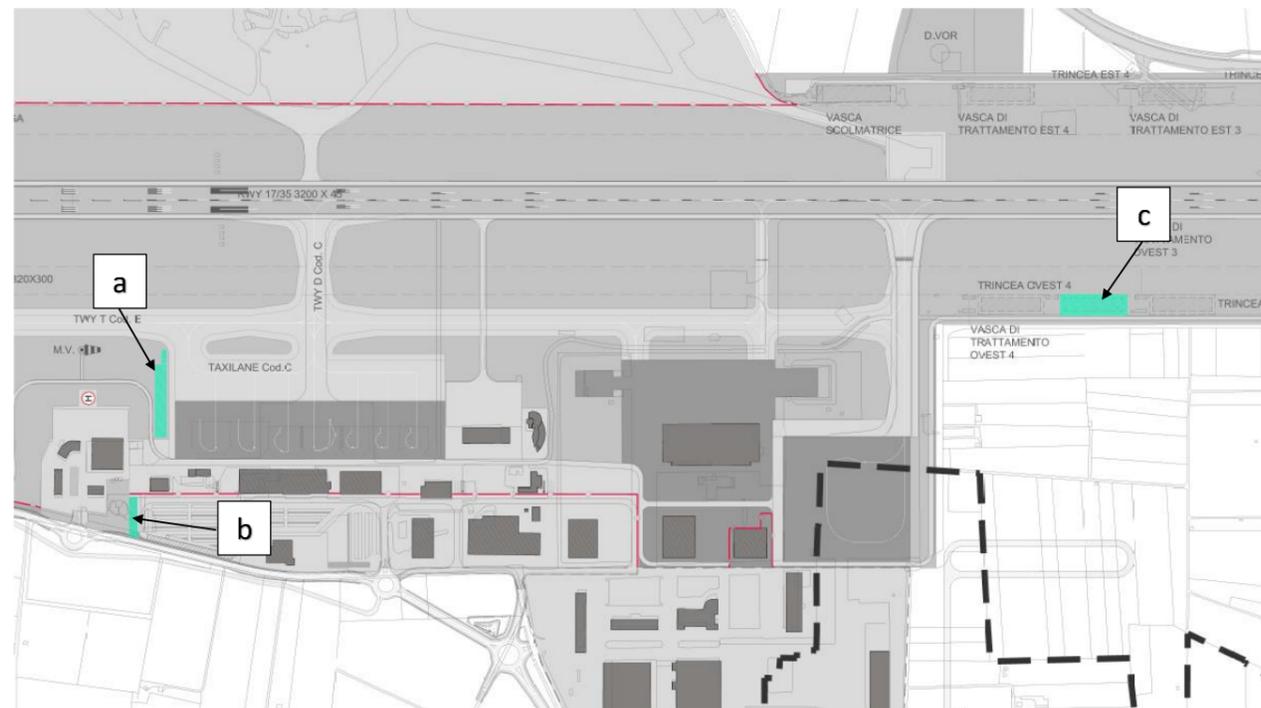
Planimetria con ubicazione degli impianti di trattamento delle acque di prima pioggia e delle trincee disperdenti.
